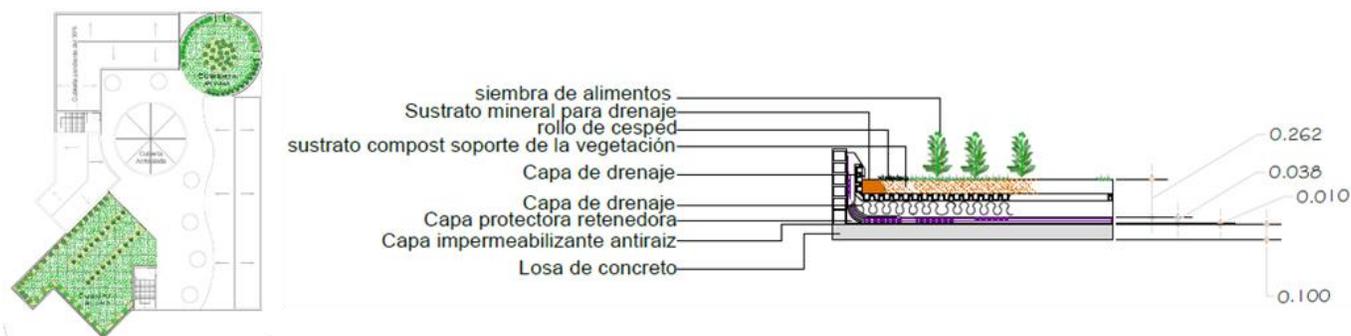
Cubierta semiintensiva y detalle en Corte de la misma.
